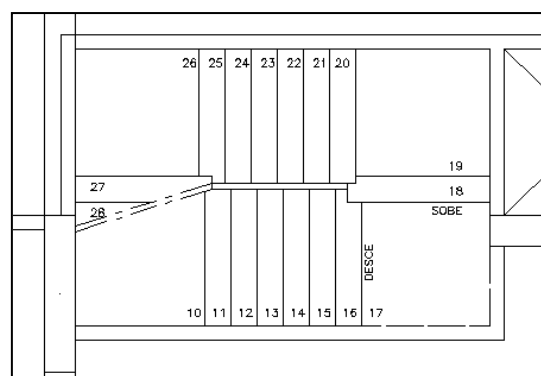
Planta baixa da escada do lobby - pavimento térreo.
